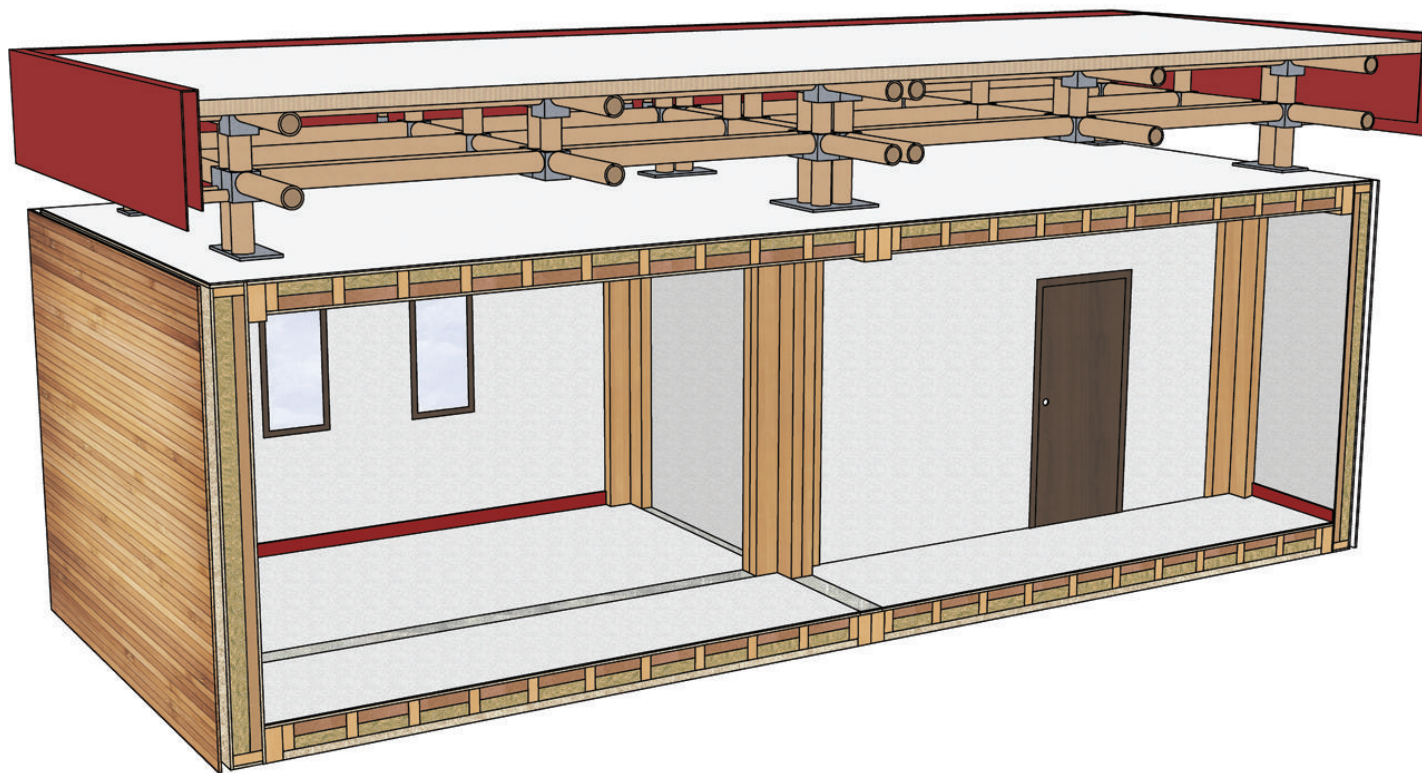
\_ Vista tridimensionale degli esterni
